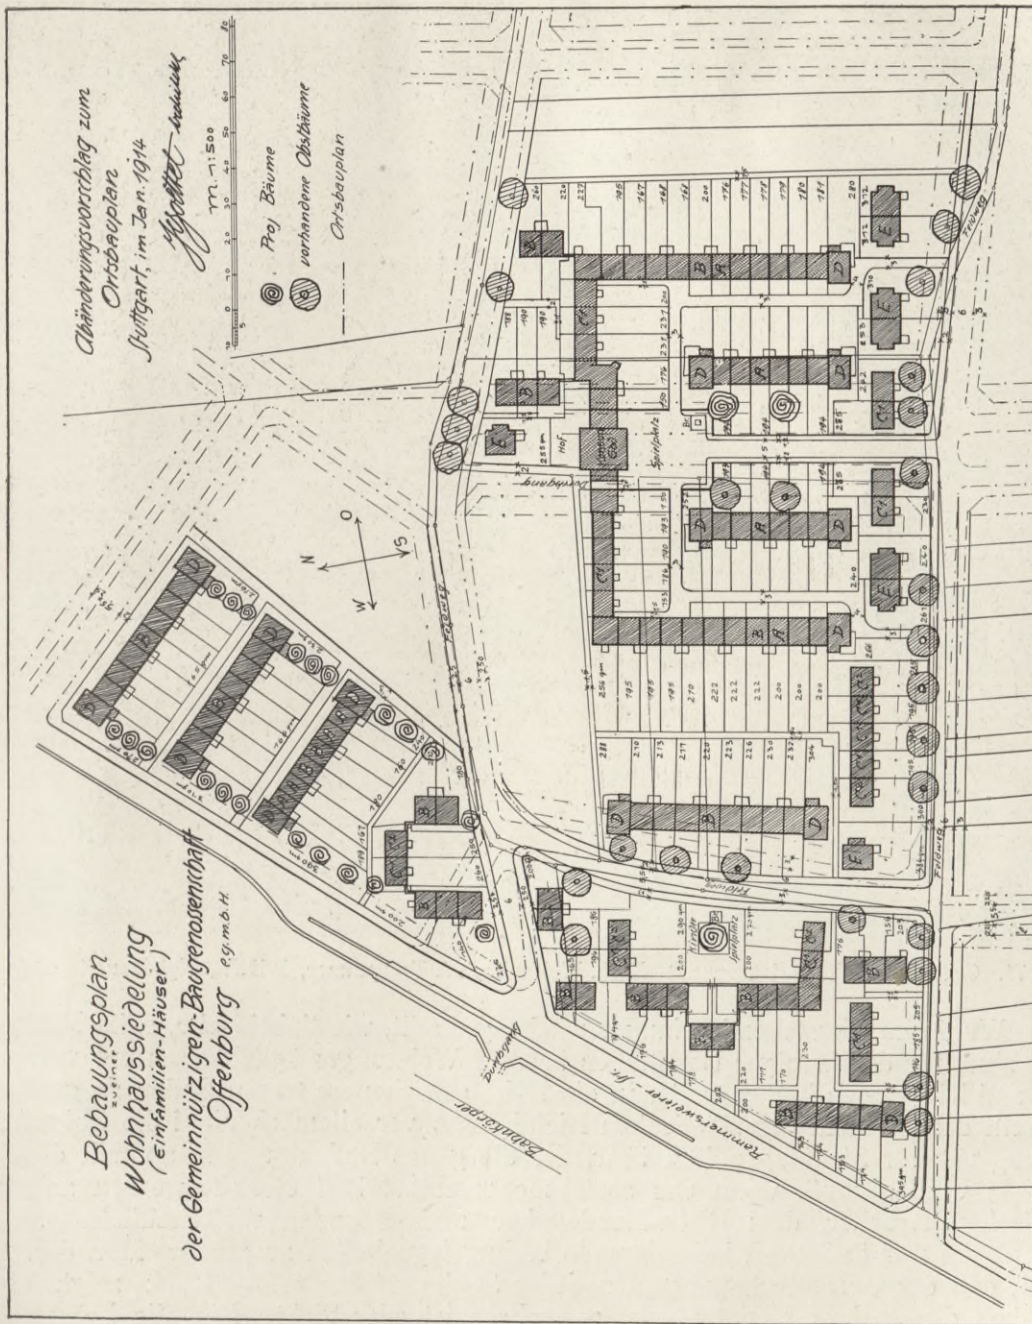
Bebauungsplan zu einer Wohnhausssiedlung der Gemeinnützigen Baugenossenschaft in Offenburg.¹⁾
